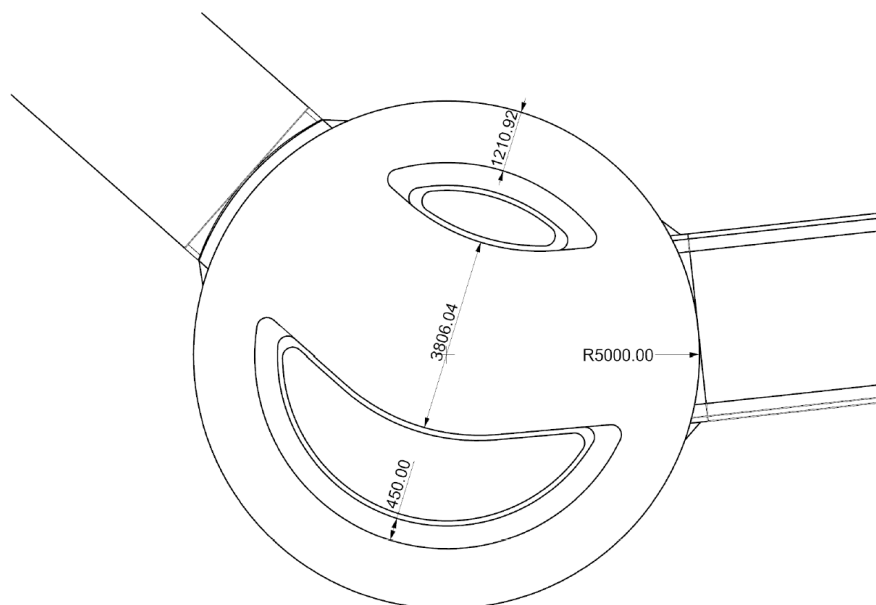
Endeavslutning på håndlistene er avrundet [3]
